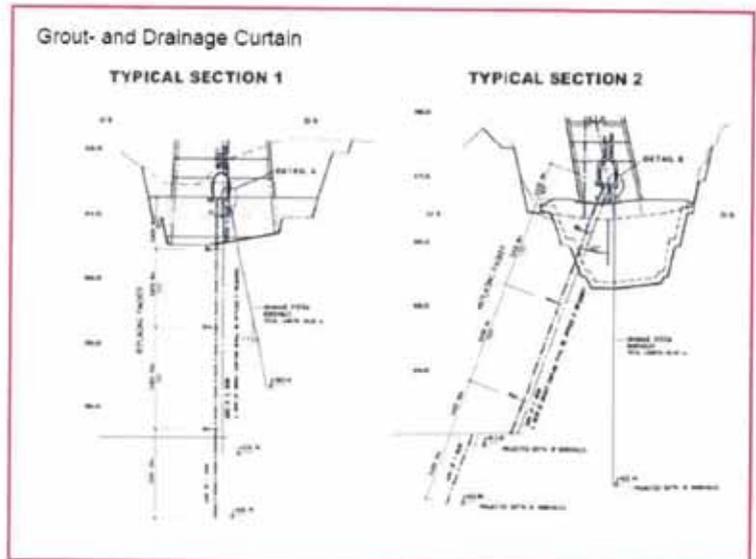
Pantalla de impermeabilización, inclinada 20° hacia aguas arriba en estribo derecho.
